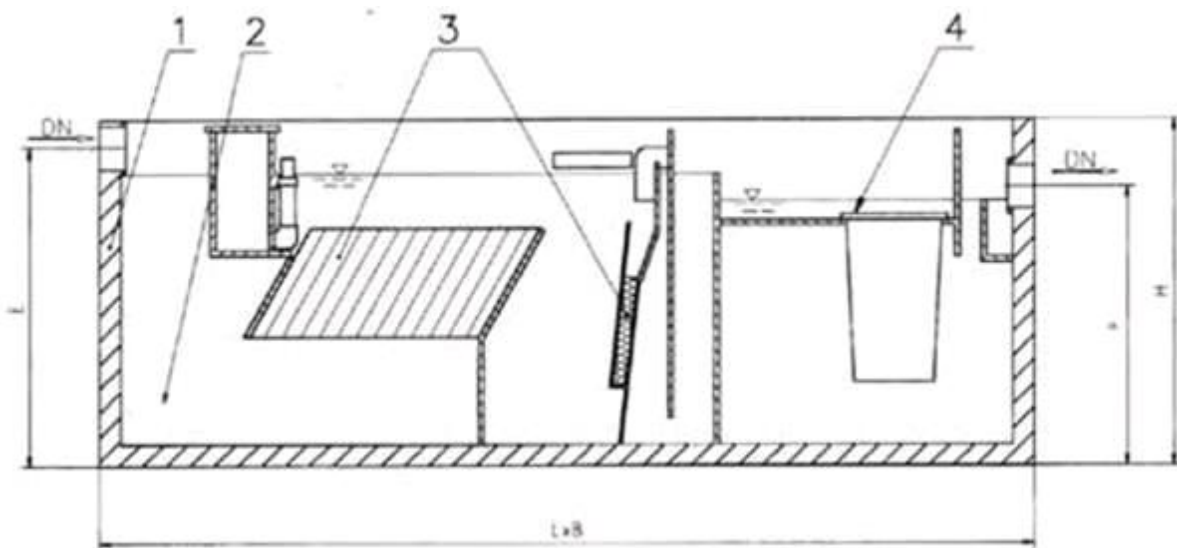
Схема сепаратора типа SOR.И – JKS:
